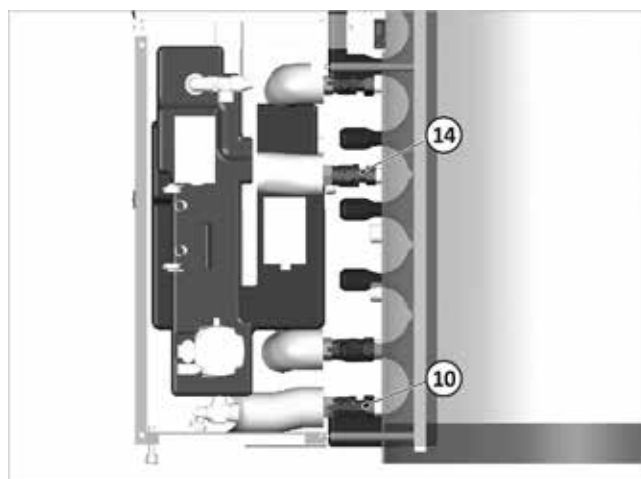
Collegamento della stazione di trasmissione del calore solare
